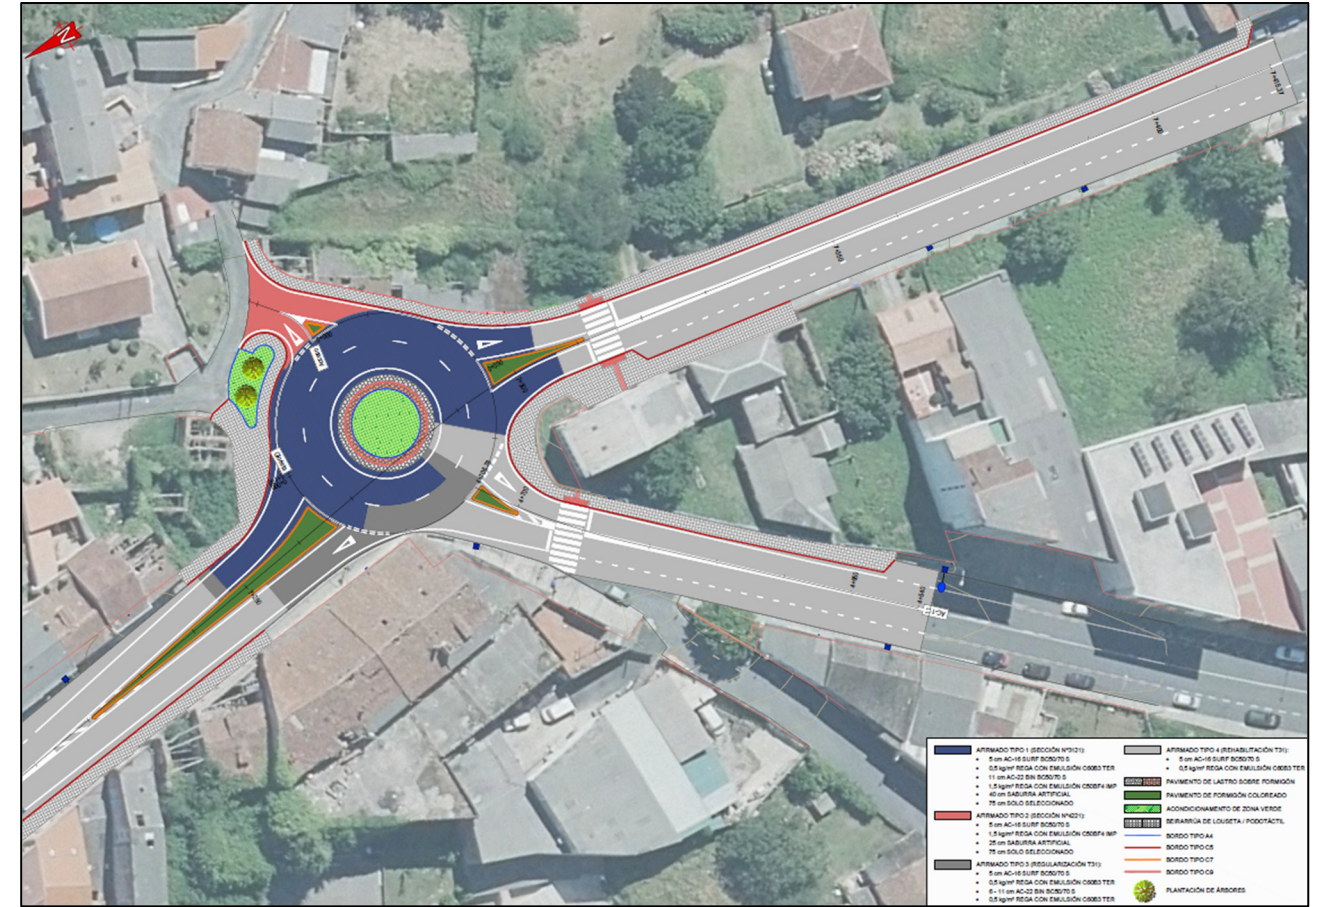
Planta de la actuación en el entorno de la intersección de las carreteras AC-862 y AC-115
